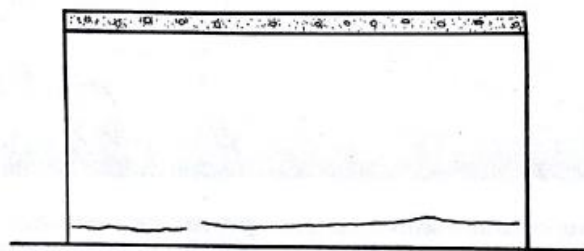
Fissuras por movimentação térmica no topo da parede
